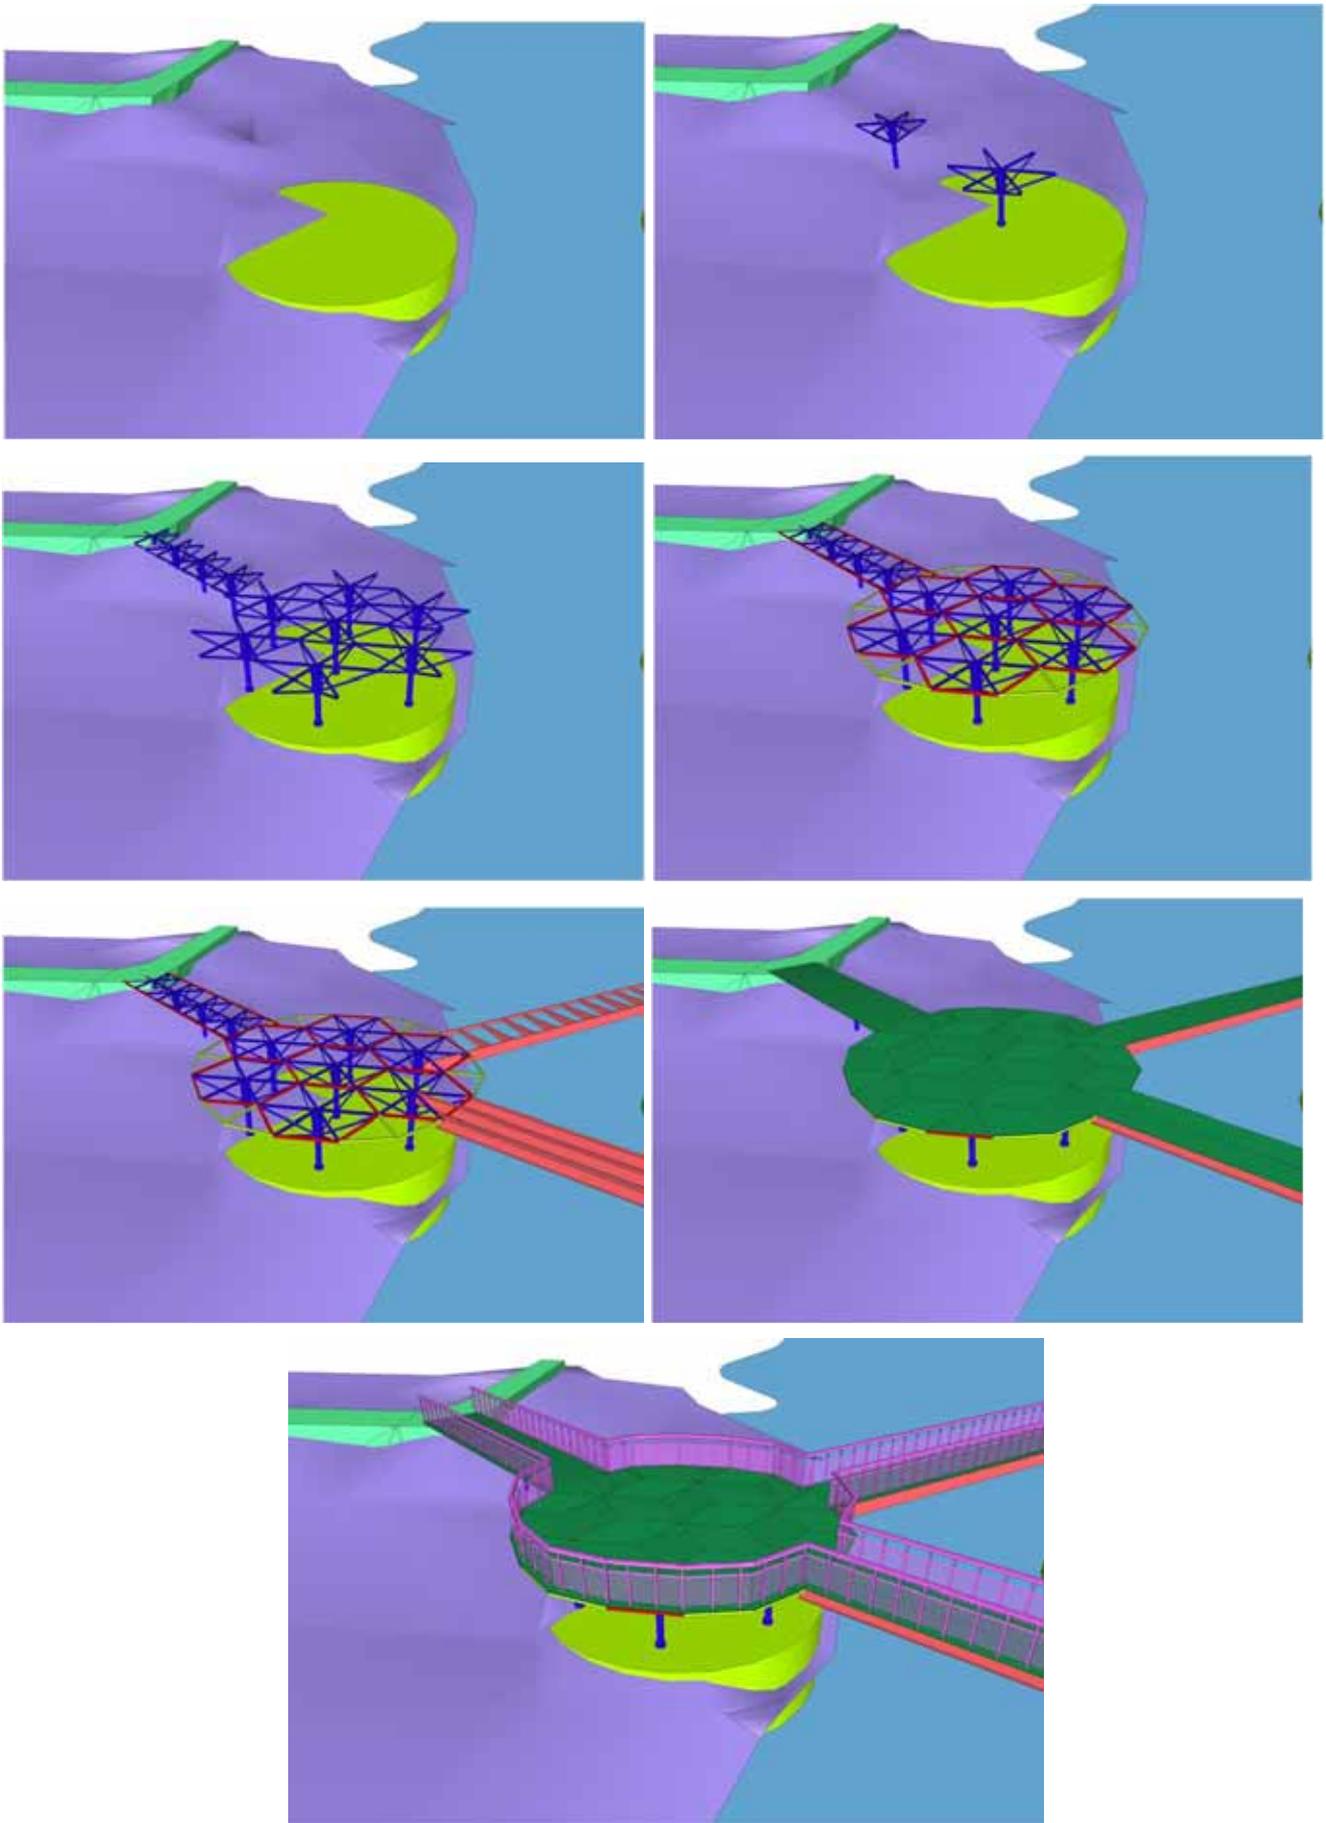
Etapes du principe constructif par structures préfabriquées - Source TICA SCE up+
